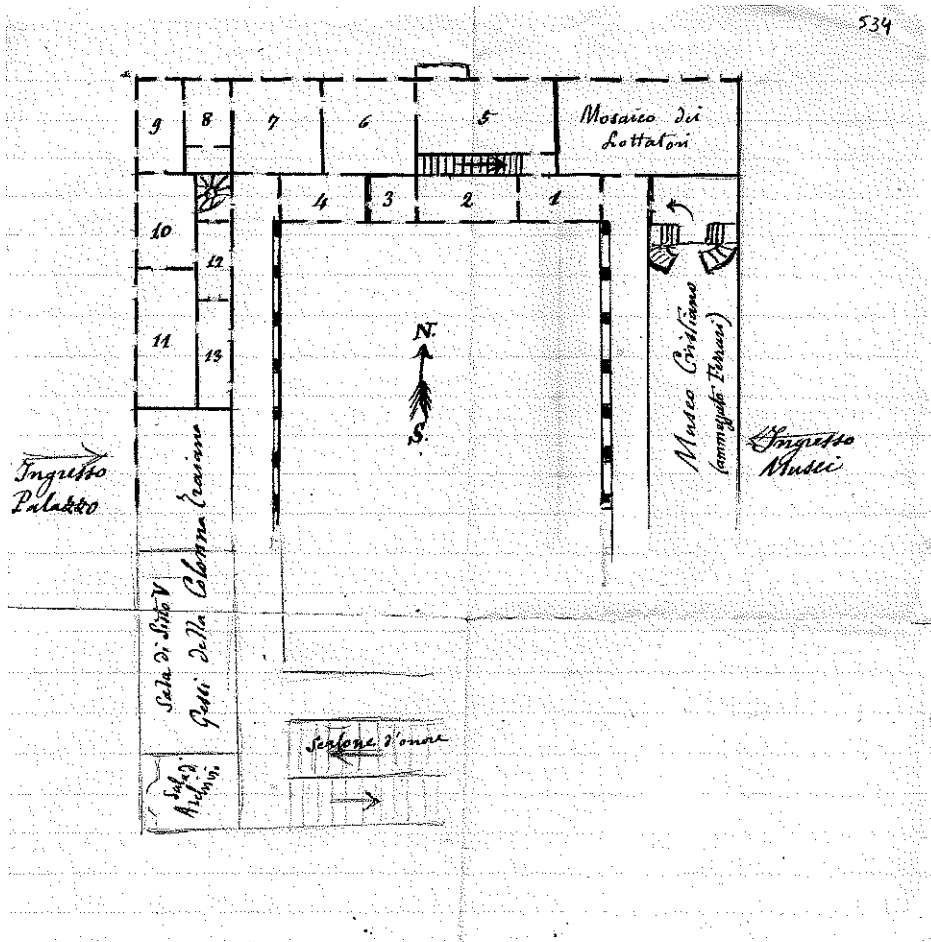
Pianta del Palazzo Lateranense (Archivio PIAC, "Fondazione e vita", fasc. 19, f. 534).
